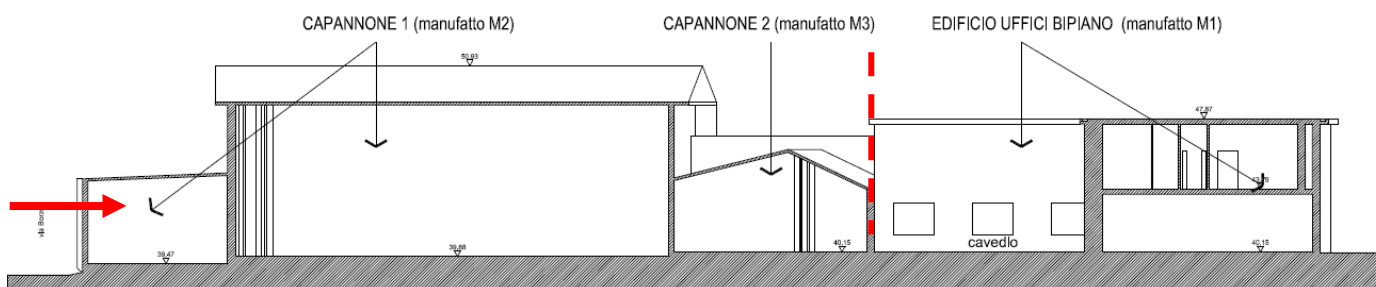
Sezione longitudinale cantiere in fase 1 (edifici M2 e M3)
